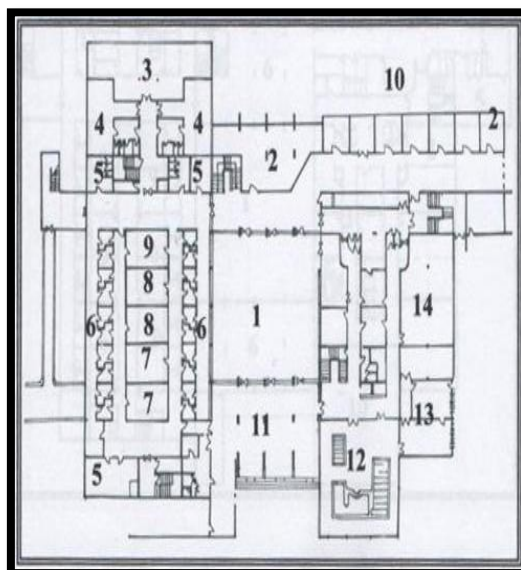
Plan RDC Hammam Essalhine –Biskra-
